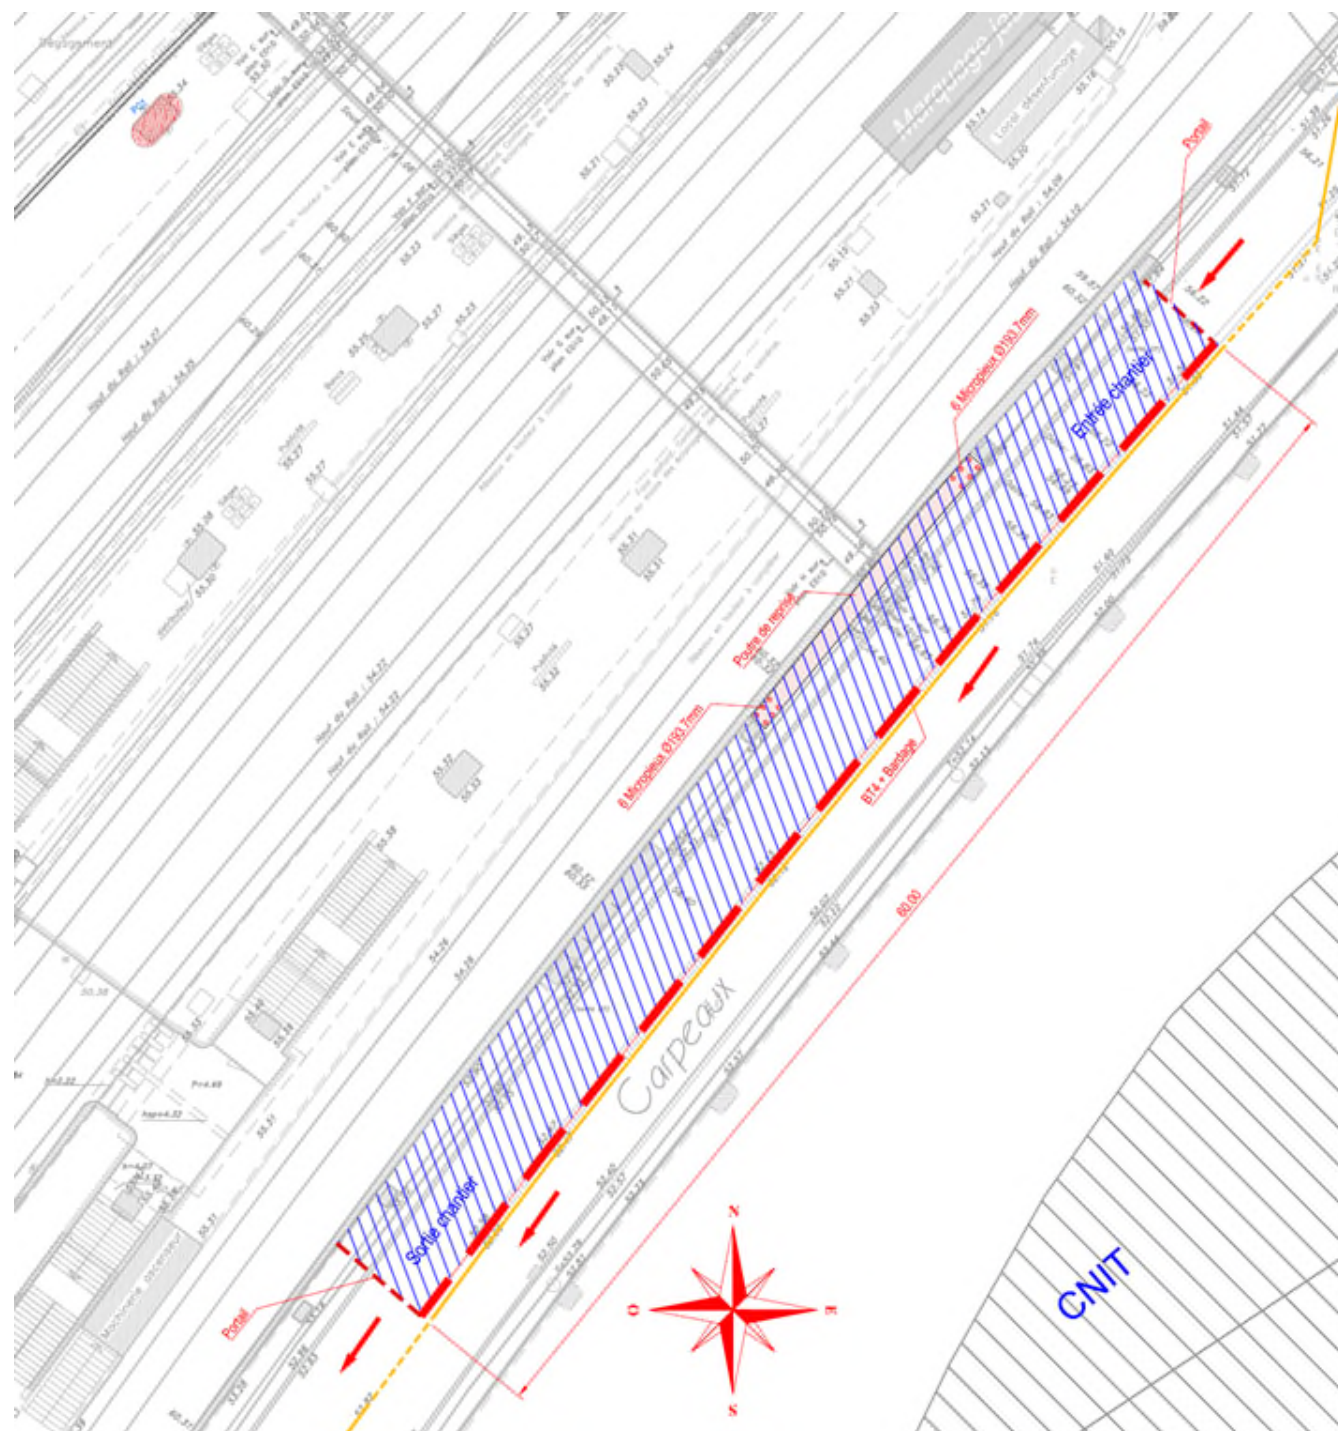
Plan d'emprise chantier rue Carpeaux (Source : SED)
